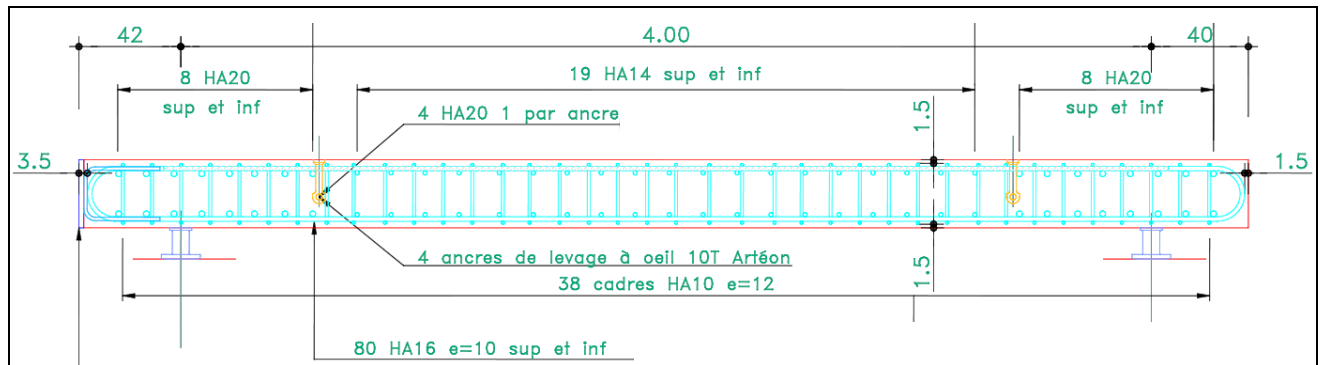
coupe dans le sens transversal de la dalle d'essai inclinée
